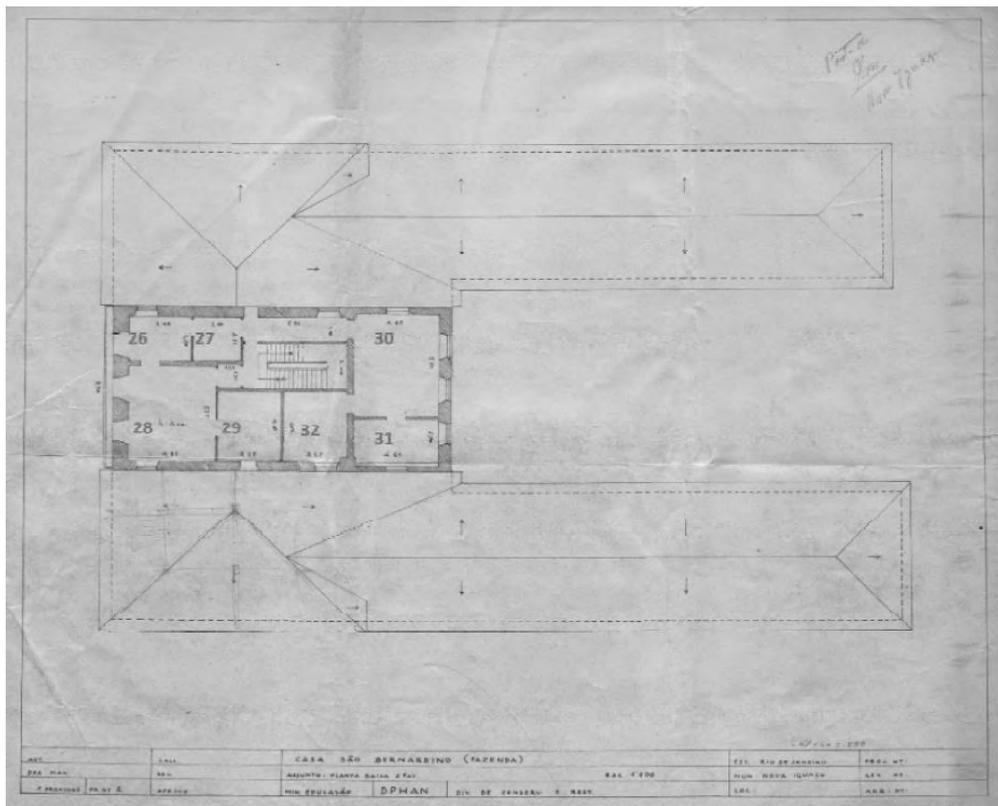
Planta baixa do 2º andar.<sup>23</sup>
